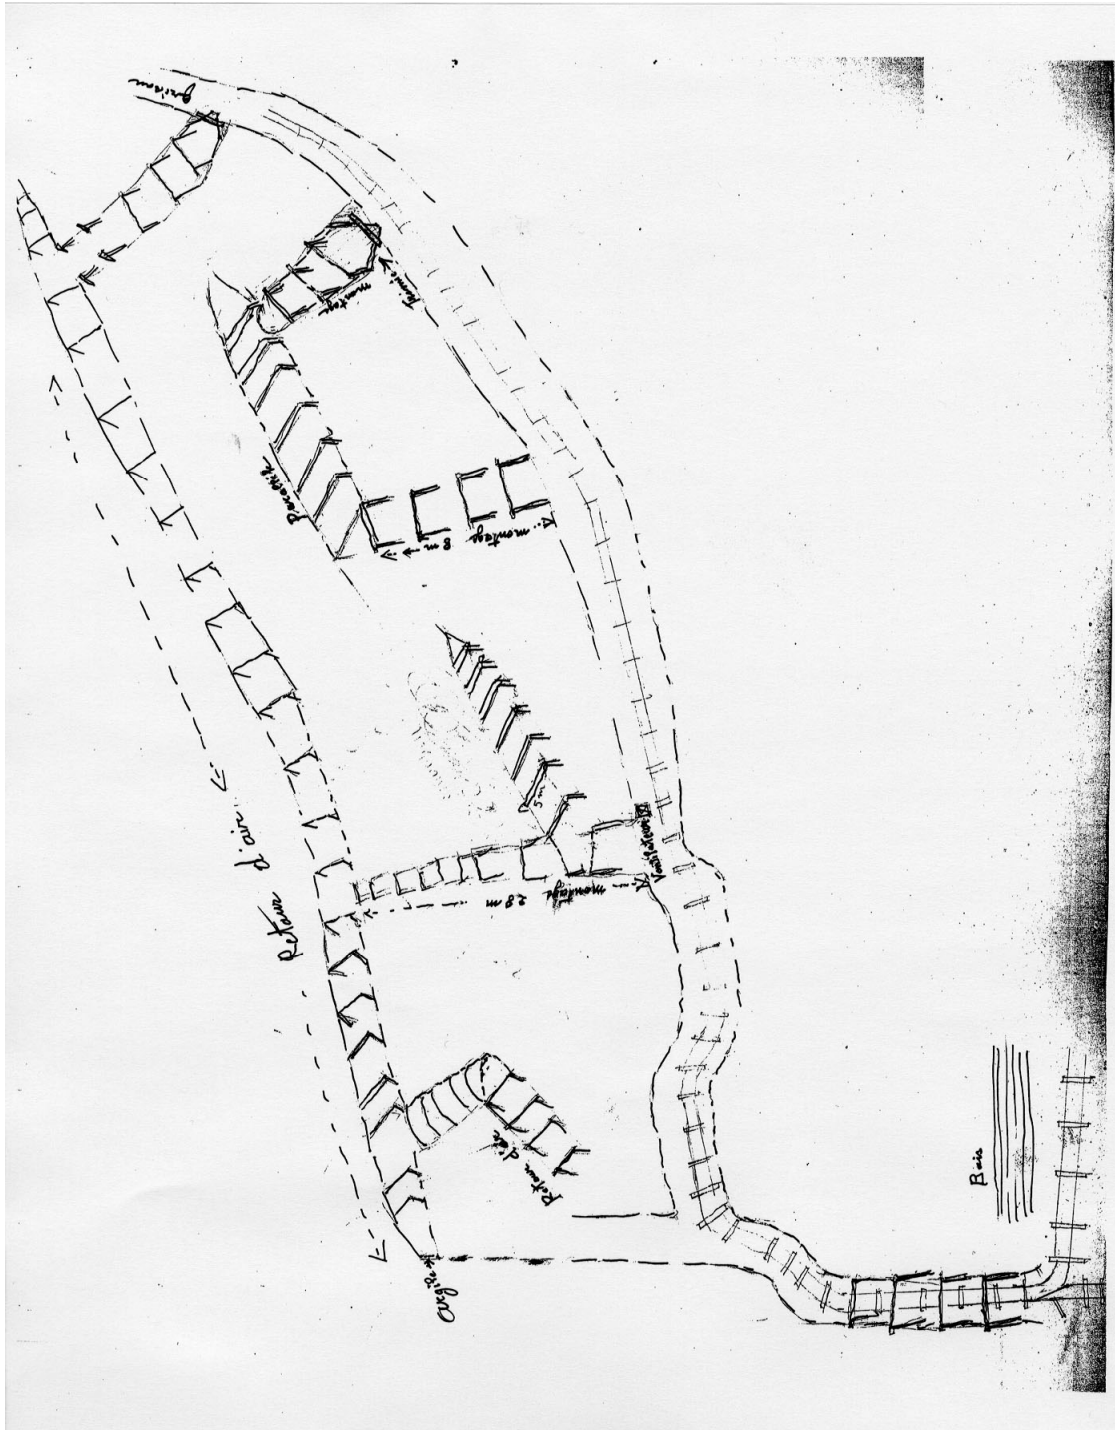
Plan de la mine de Saint-Jean par Louis Colombar
